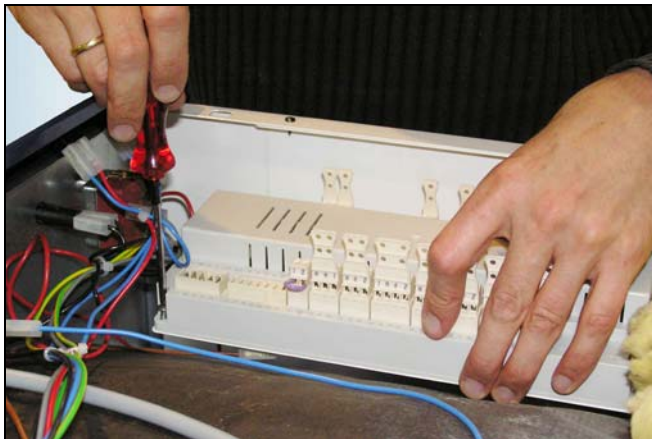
Den Kesselregler mit 4 Blechschrauben auf das Halteblech schrauben.
